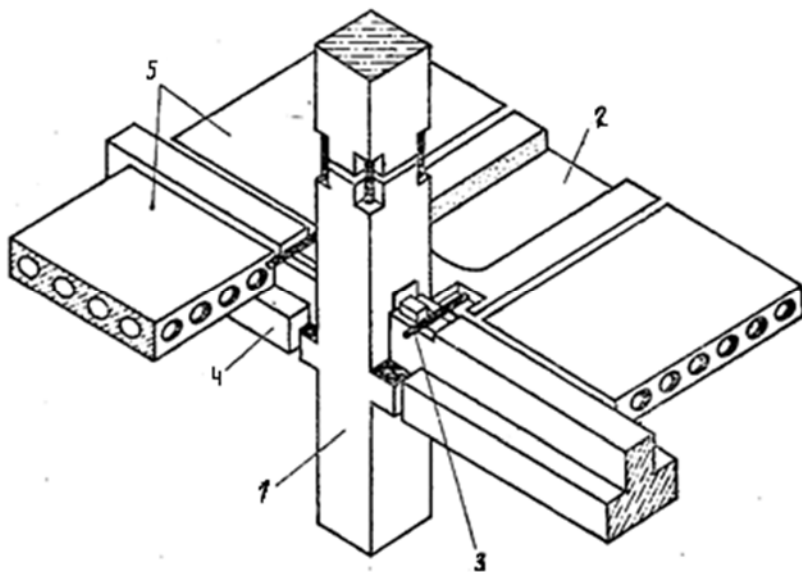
Сопряжение колонны со сборным перекрытием (серия 1.020):
